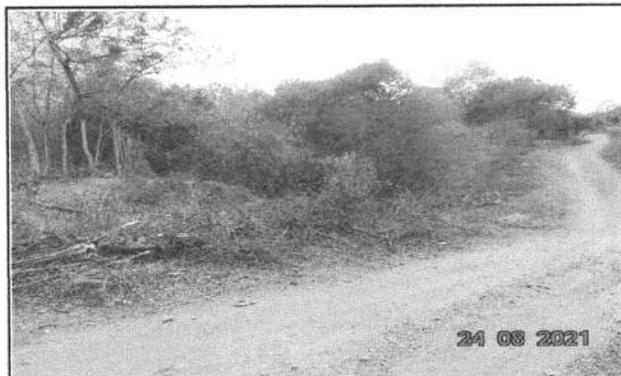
LOCAL DA CONSTRUÇÃO - BUEIRO
